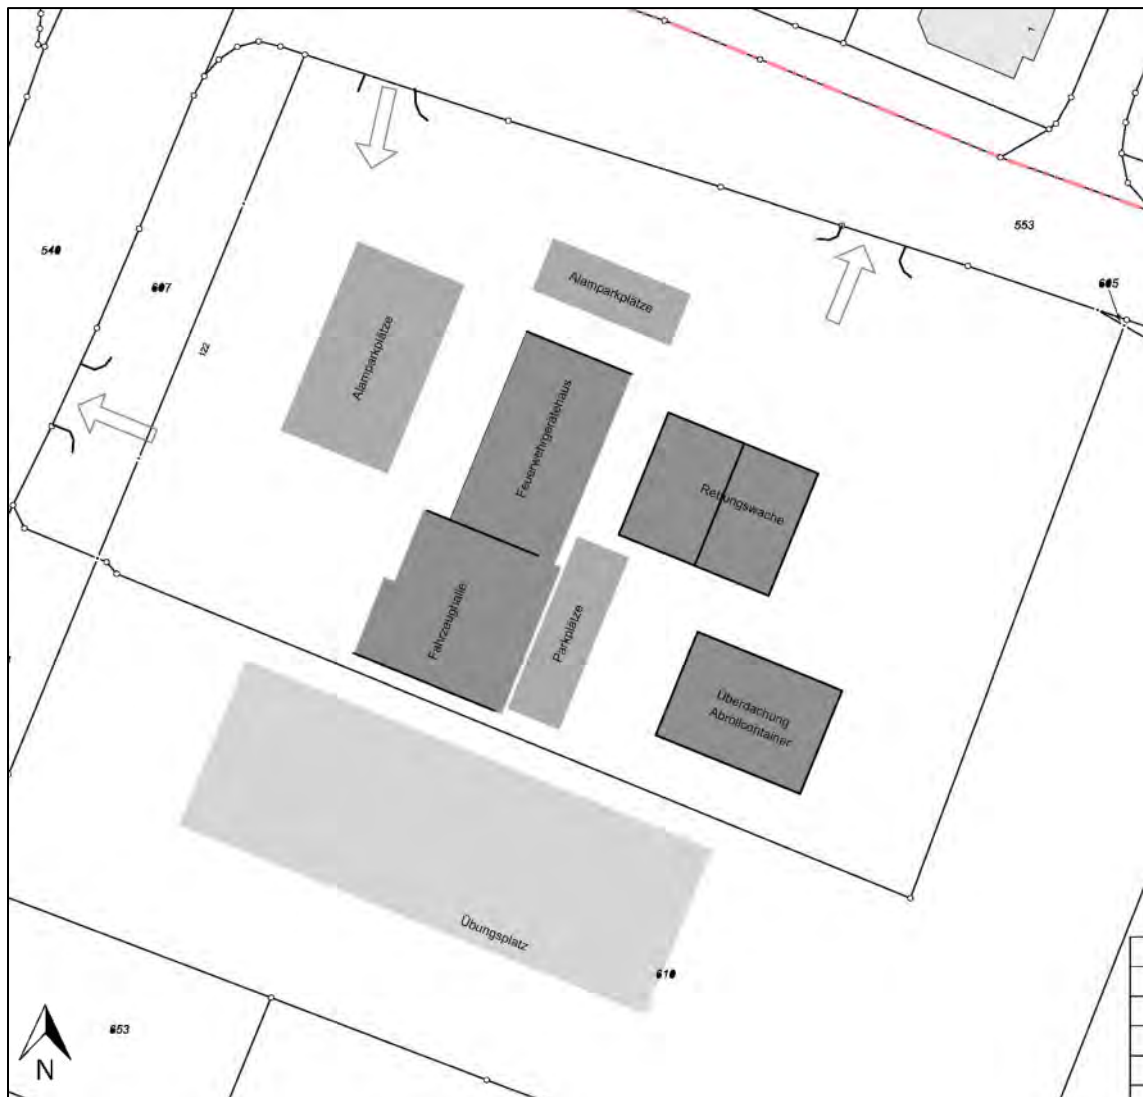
Lageplan Feuerwehrgerätehaus und Rettungswache /14/
